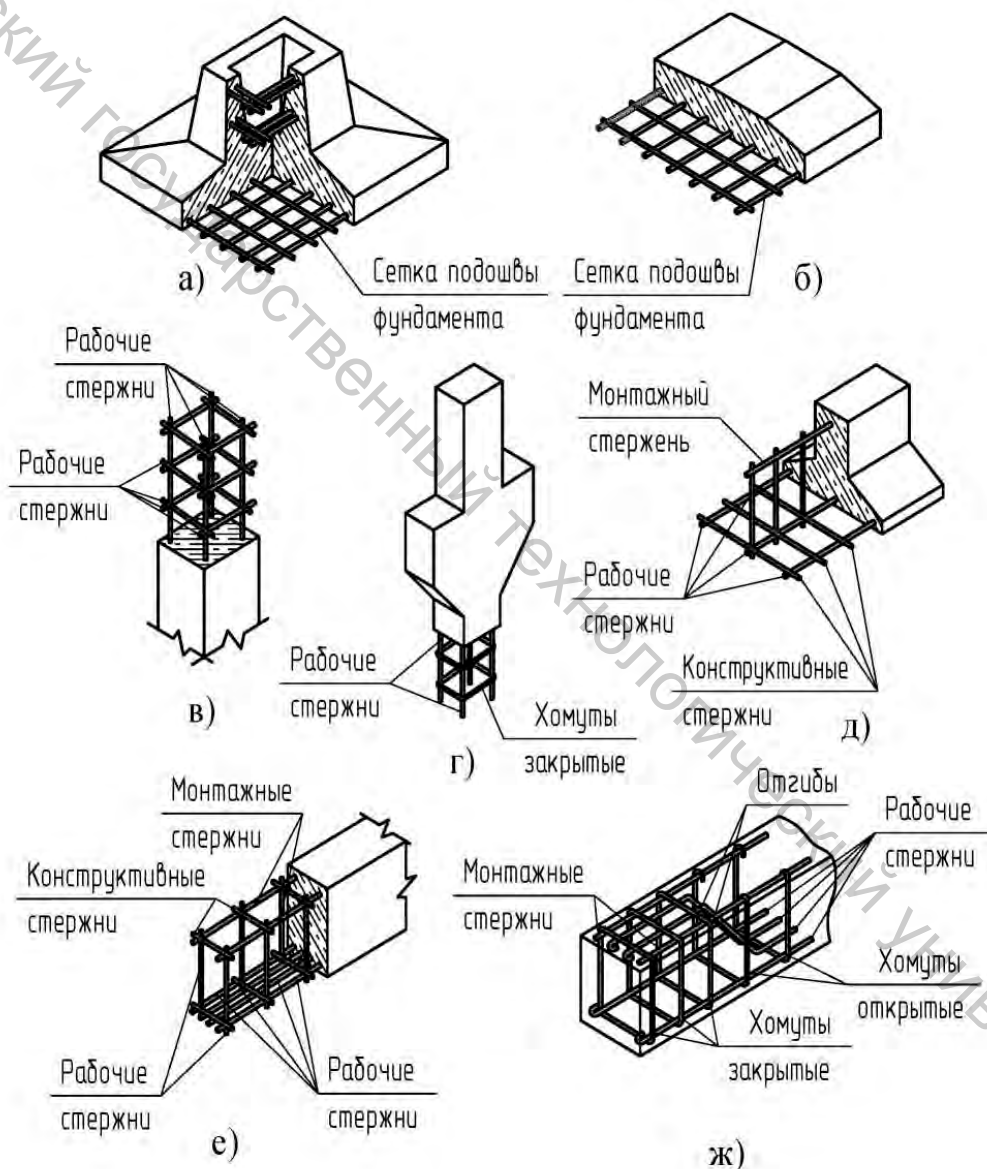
Типовые железобетонные изделия и их армирование:
